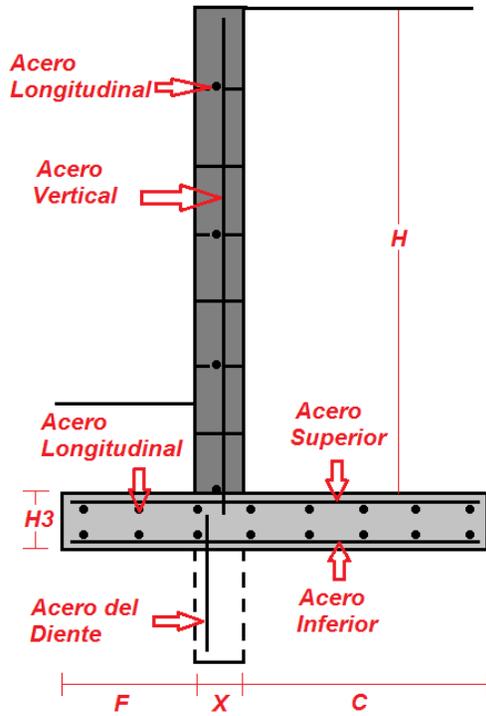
Colocación del acero para un muro de contención en mampostería tipo voladizo
